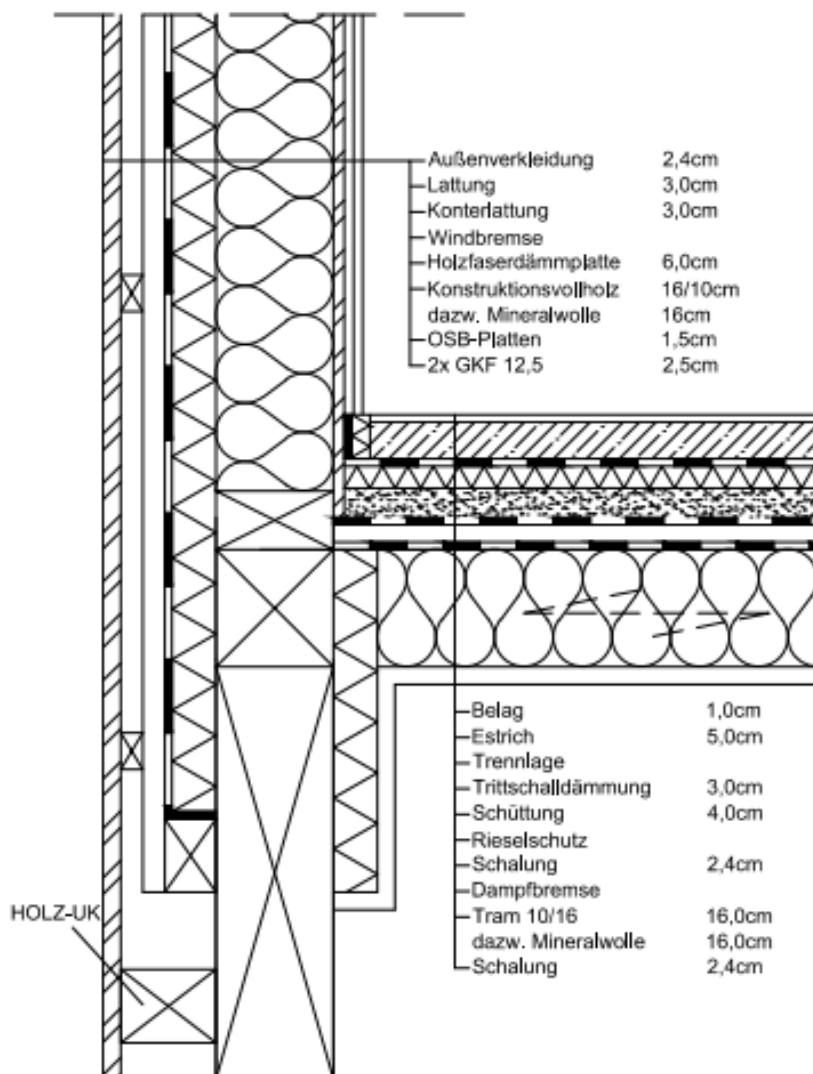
Detail 03 - Anschluss Decke EG an AW
